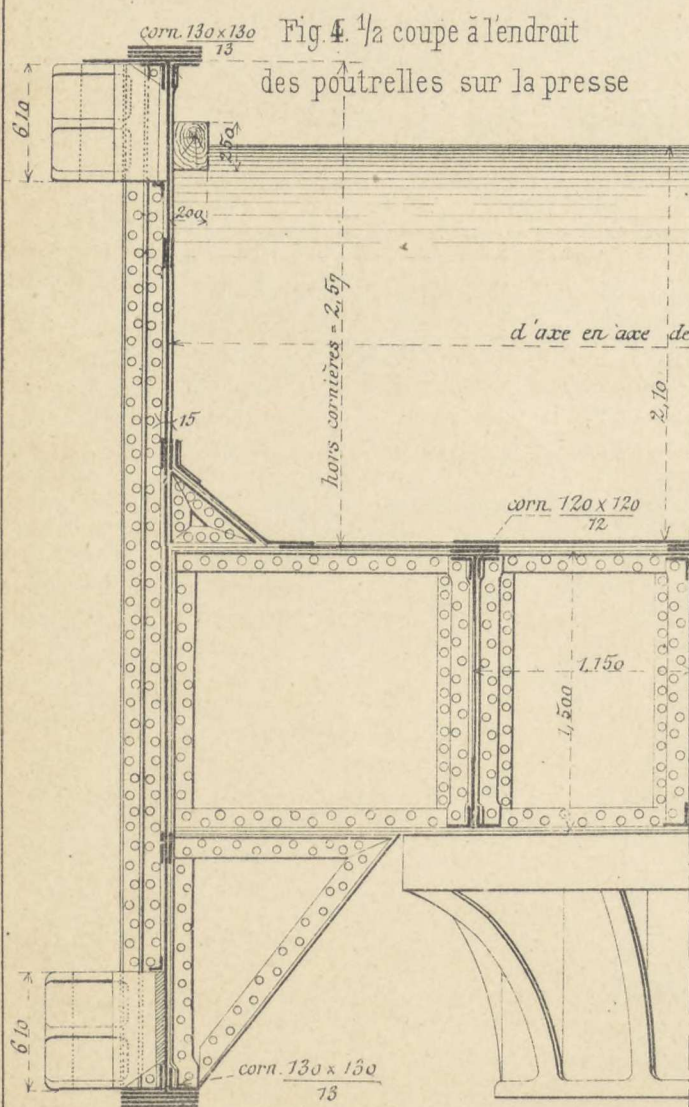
$\frac{1}{2}$  coupe à l'endroit
